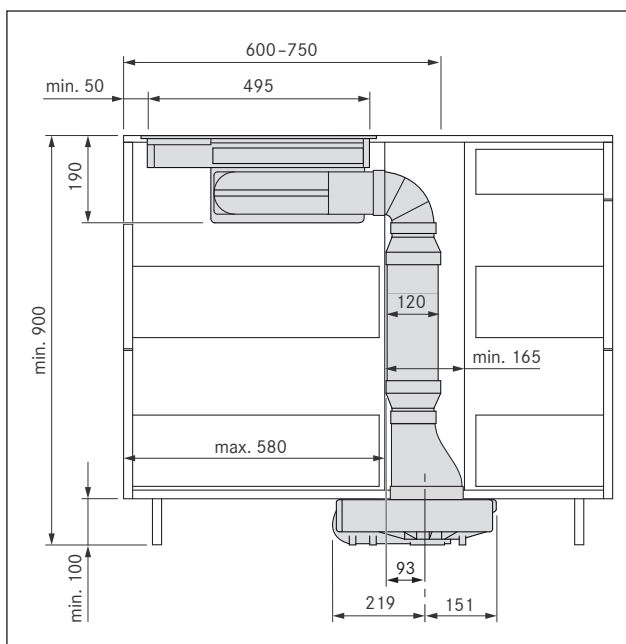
Indbygningsmål med flad lydæmper USDF ved montering i en køkkenø
